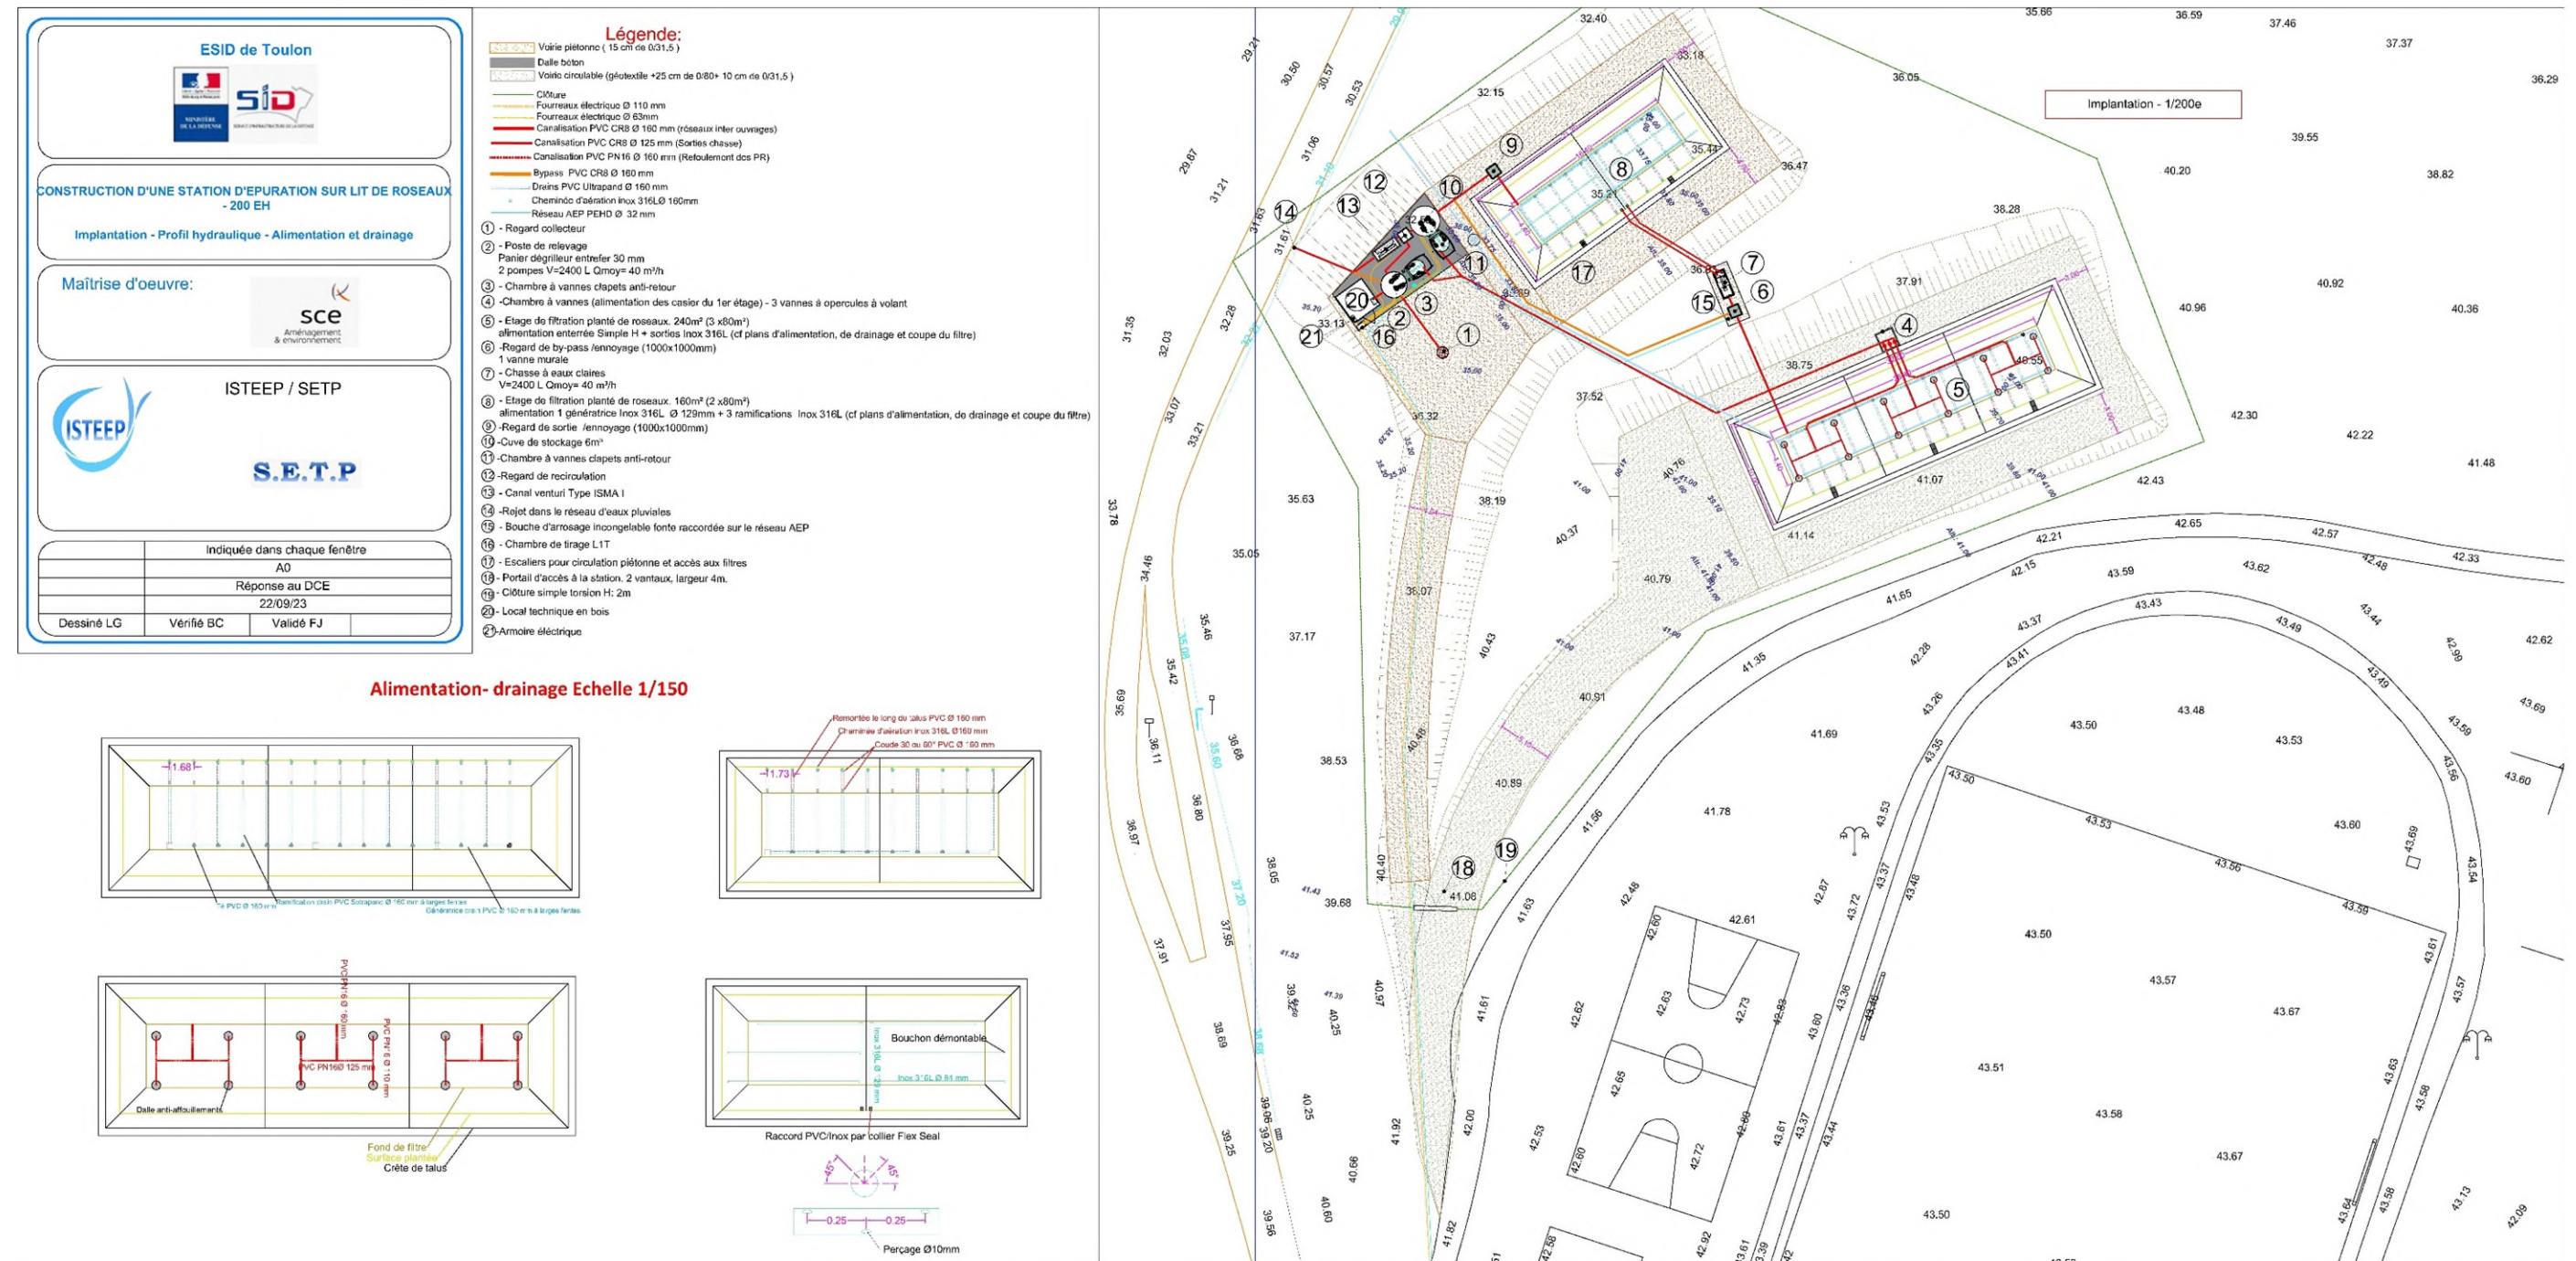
Plan d'implantation de la STEP (source : ISTEPP)
